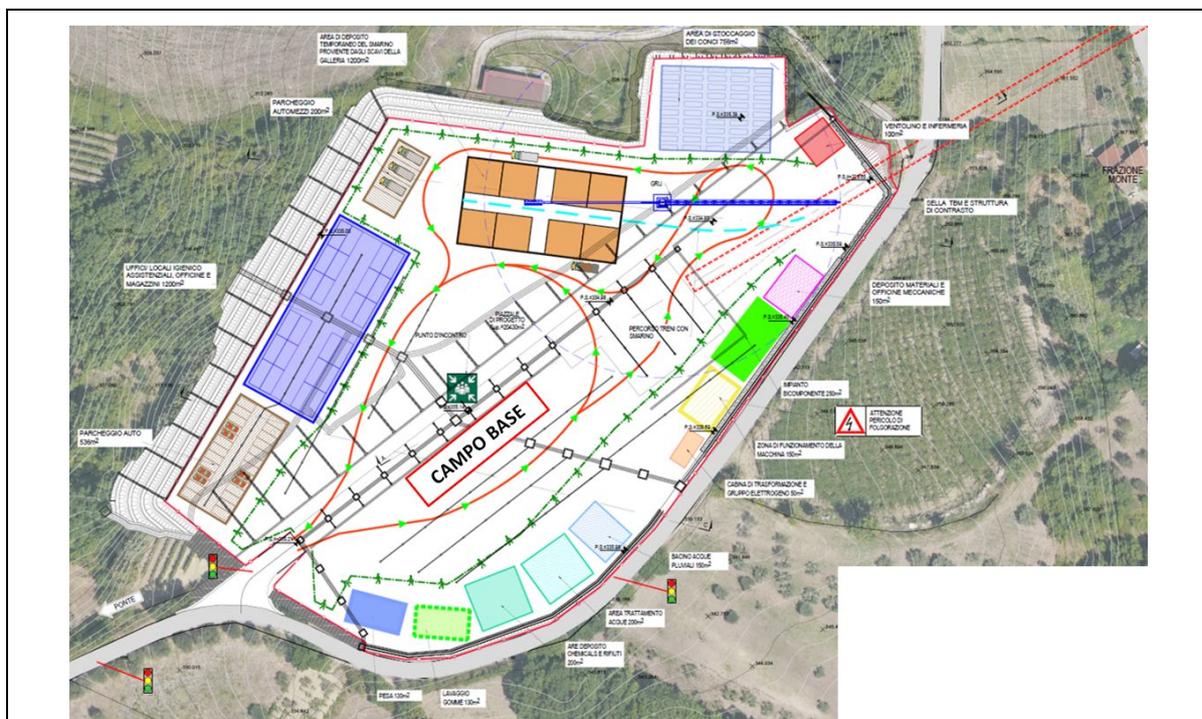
Layout campo base CB e cantiere scavo galleria di derivazione (COS1)
